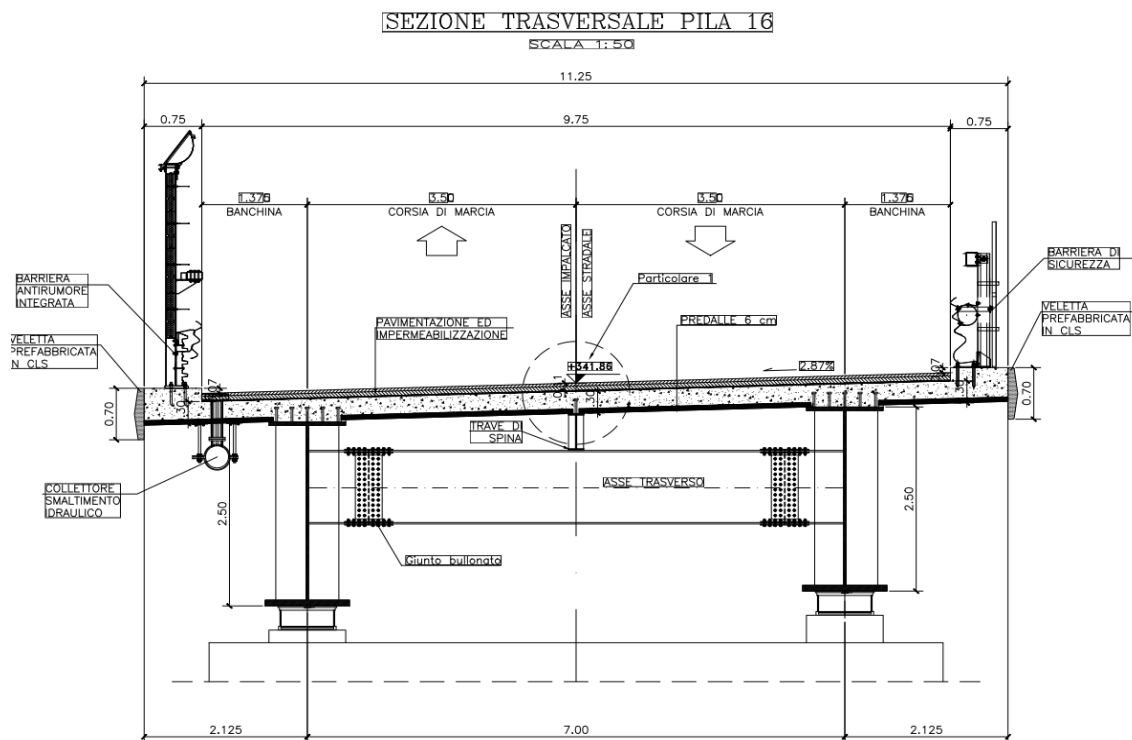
Sezione trasversale dell'impalcato - sezione su pila tipo (sezione tipo2)
